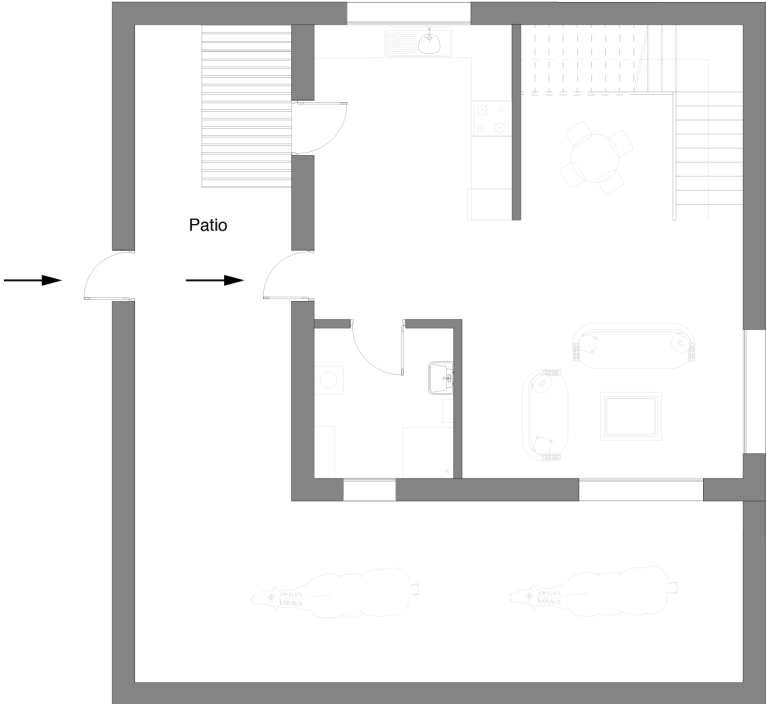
Plan du rez-de-chaussée de l'habitation type 2
